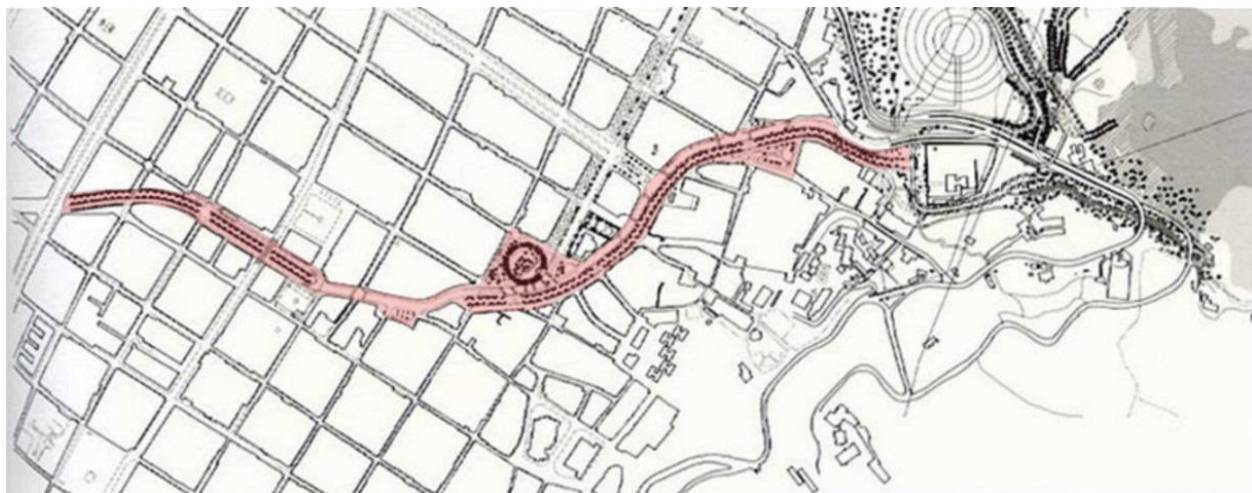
Planta General de la intervención (Área Aproximada 2Ha.)
